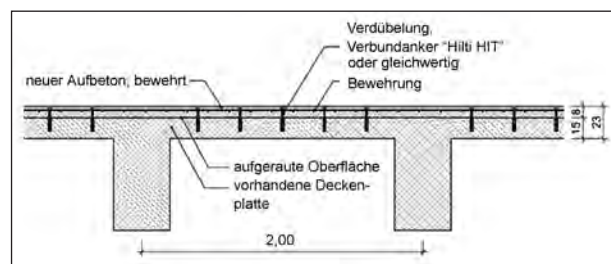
Verstärkung einer Deckenplatte durch Aufbeton (EmSe-He09)
